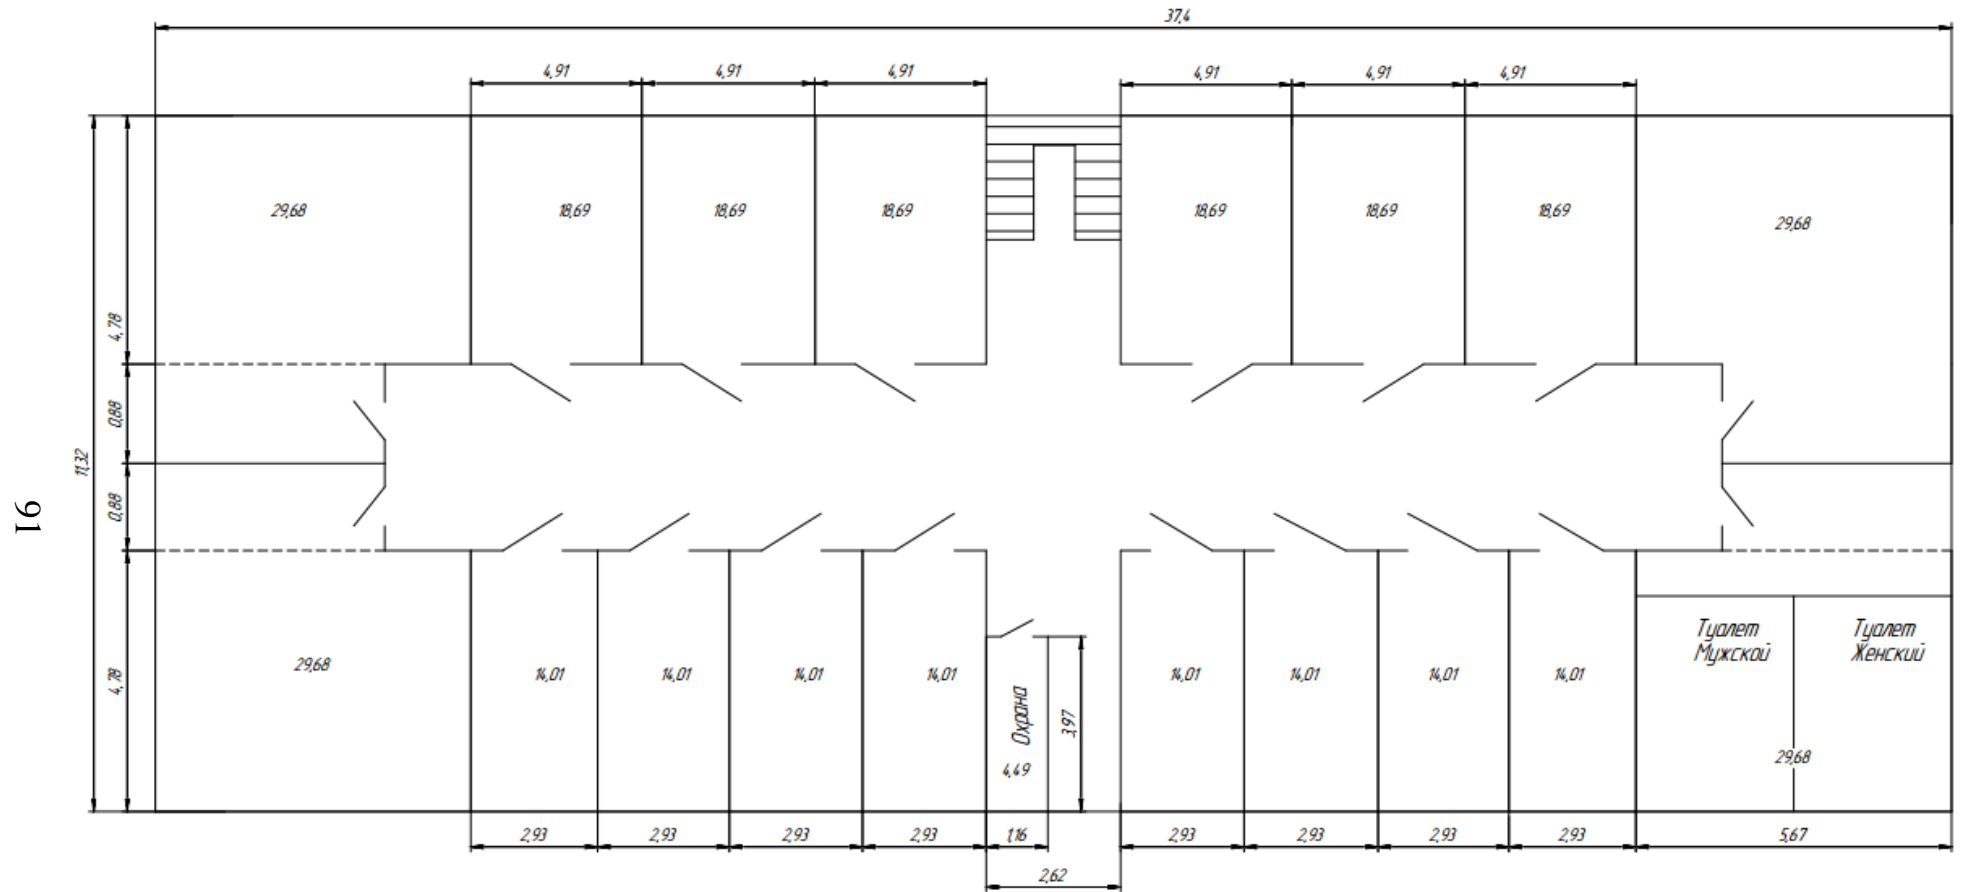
План 1-го этажа здания площадью 423,39 кв.м.
